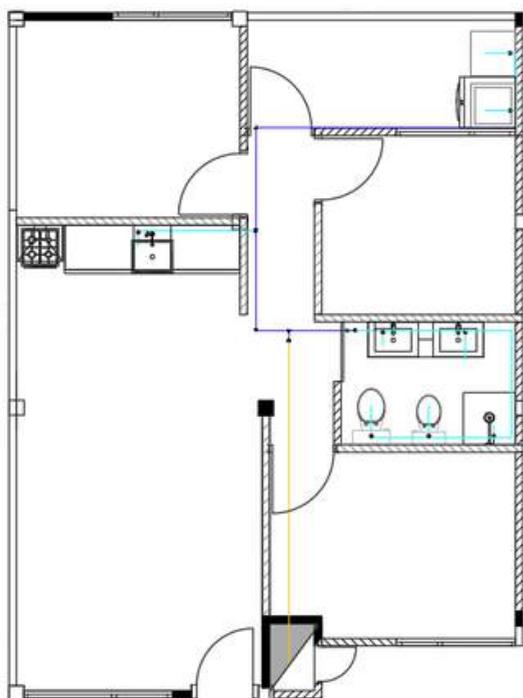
Planta de Alcantarillado e Hidrosanitario. Elaboración propia
